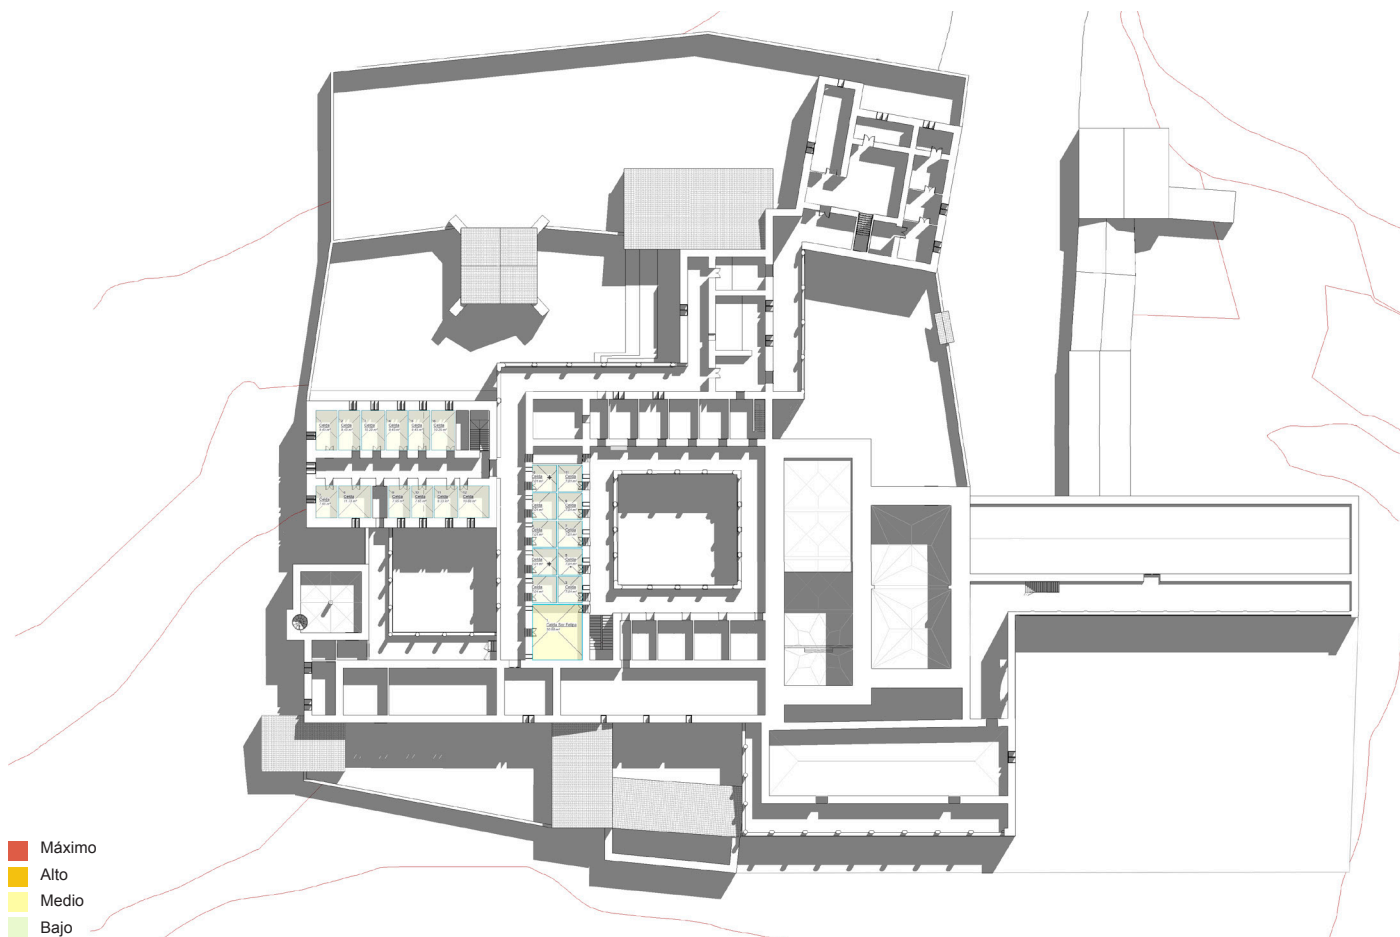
| Visualización de Nivel de Urgencia | Planimetría +5.00m
